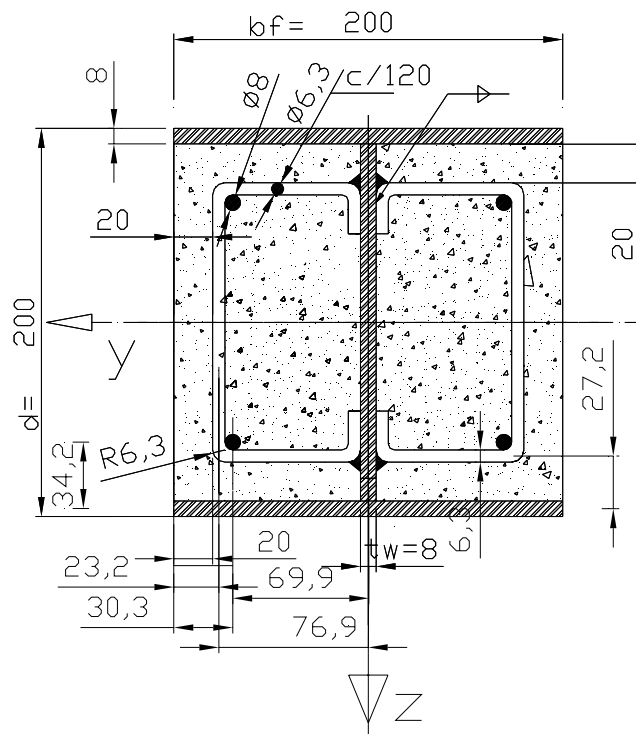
Seção transversal típica dos pilares ensaiados.
